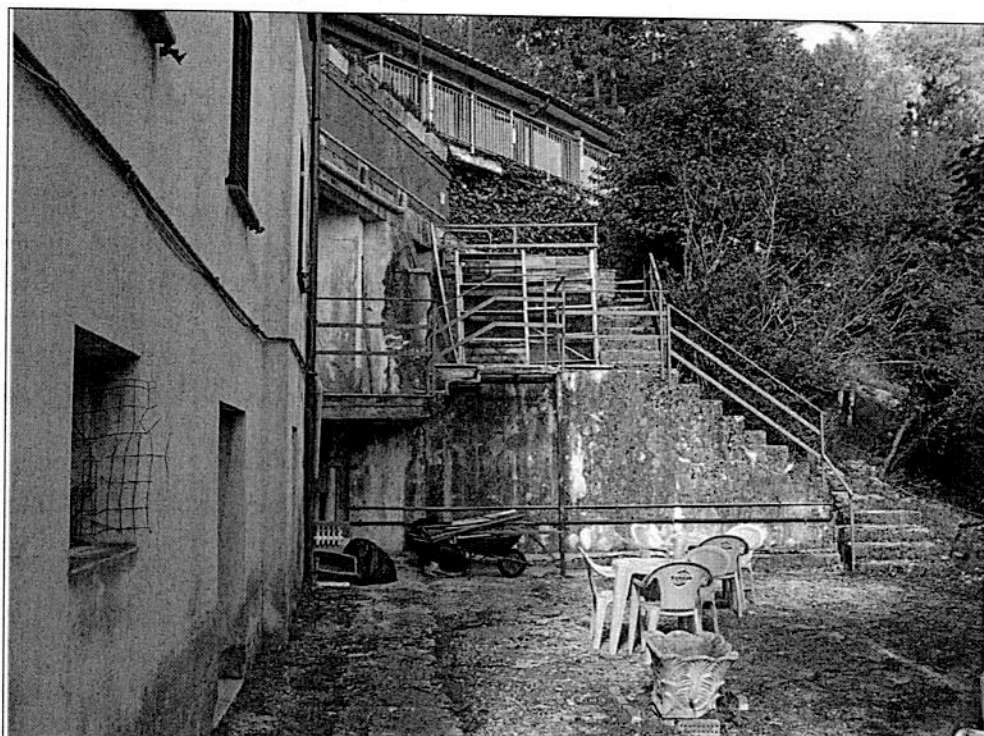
rampe di scale esterne colleganti la corte nel piano S3 ai piani superiori
